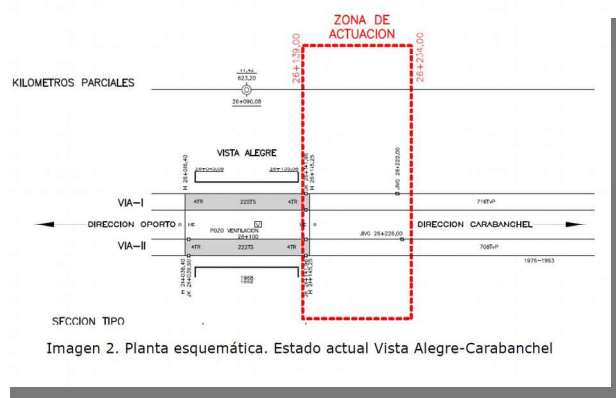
Planta esquemática. Estado actual Vista Alegre-Carabanchel
